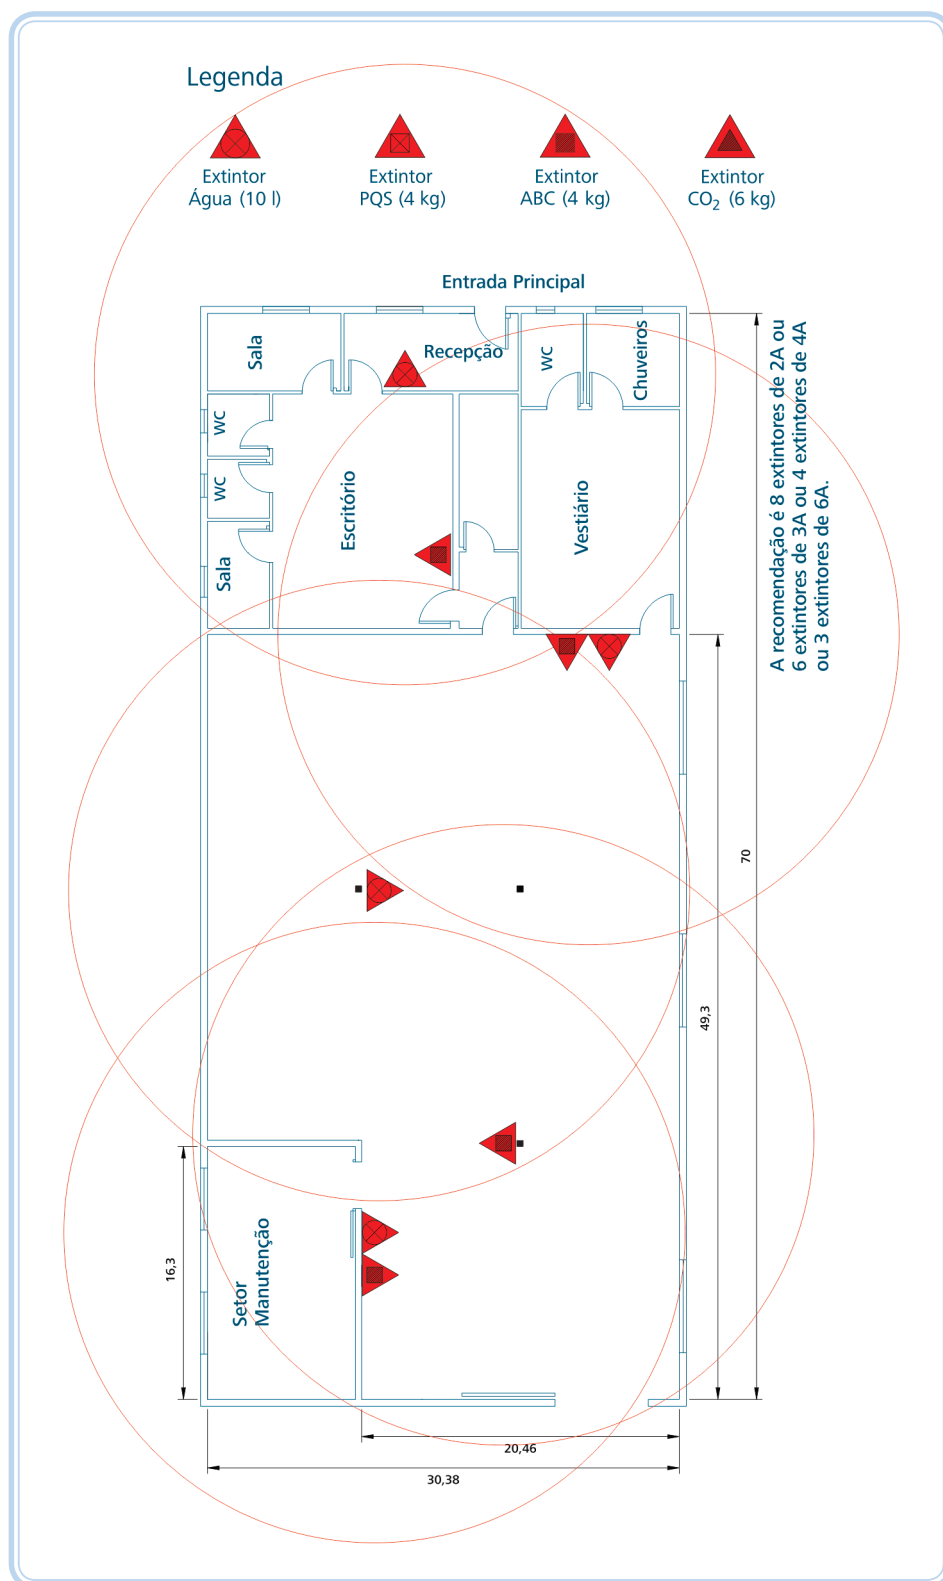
Planta baixa da empresa para distribuição dos extintores
